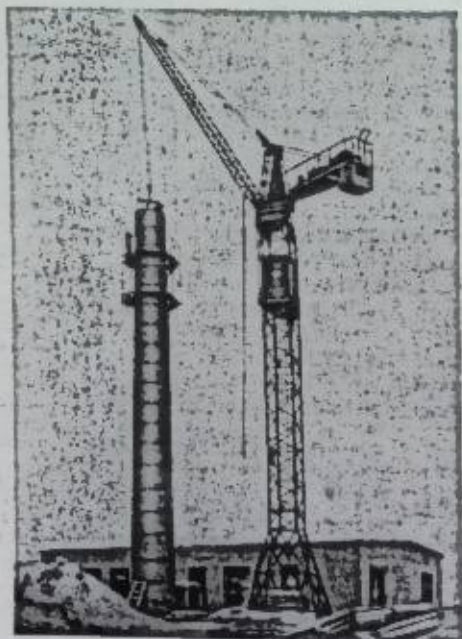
Монтаж железобетонной конической трубы из крупных железобетонных блоков.
